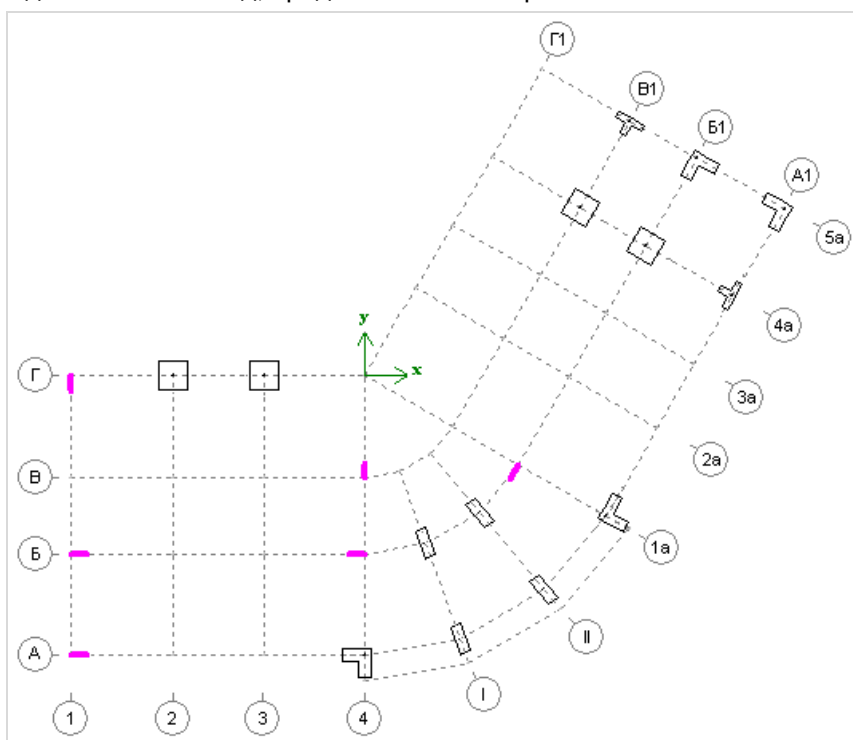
Копирование короткой стены (пилона) вокруг точки
